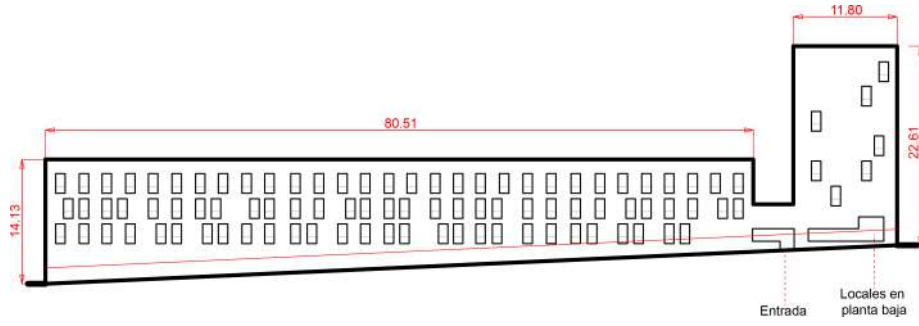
Alzado de Carabanchel 3 en la calle del Salvador Allende
